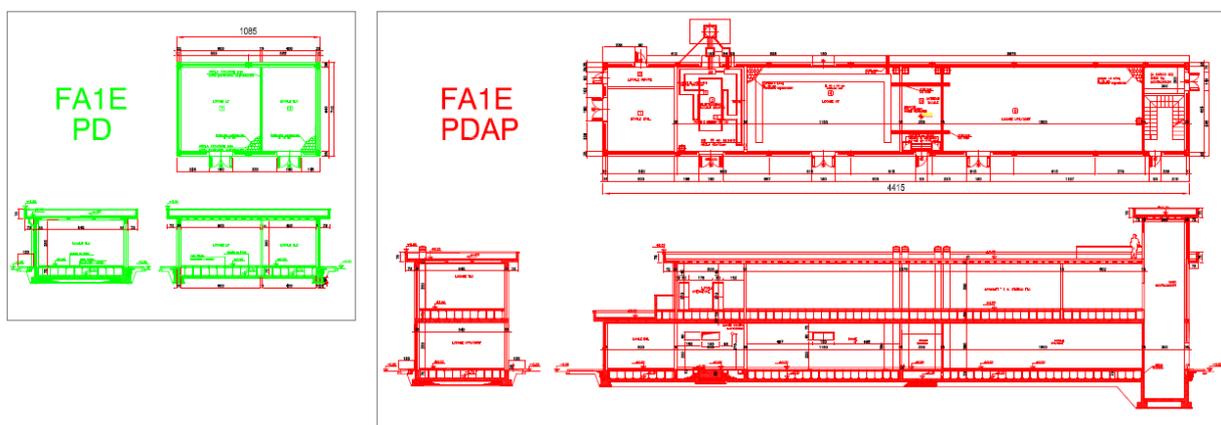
A sinistra planimetria e sezioni della versione PD e a destra la versione PDAP
